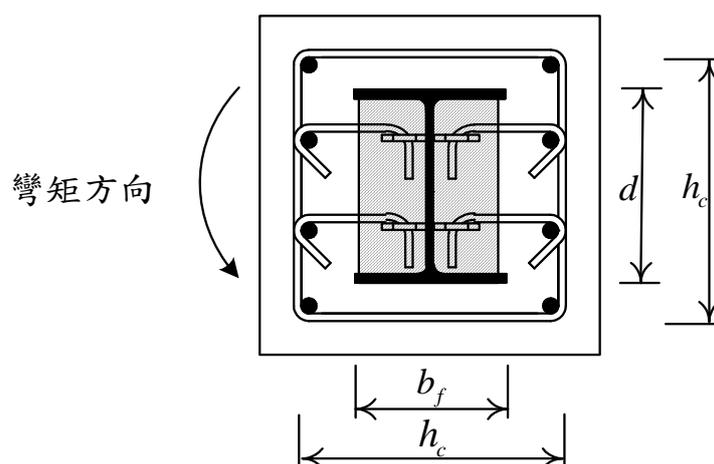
TSRC 斷面鋼骨所圍束之混凝土
